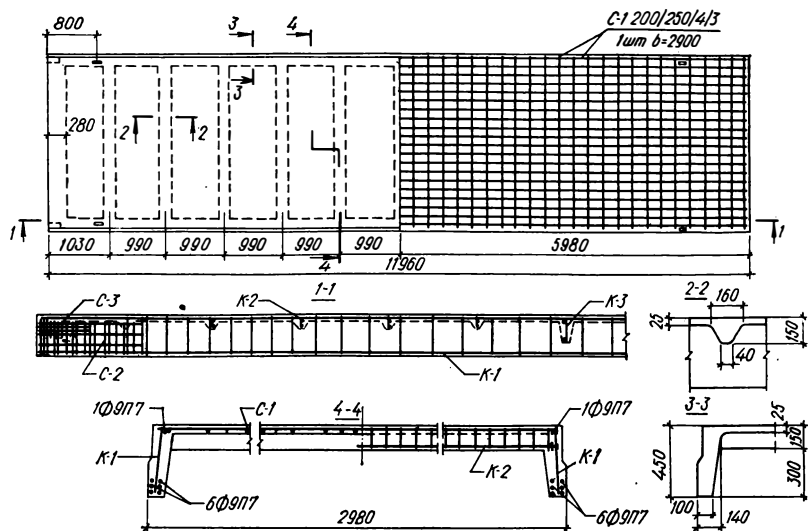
Опалубочный чертеж и армирование предварительно напряженной панели покрытия 3×12 м.
